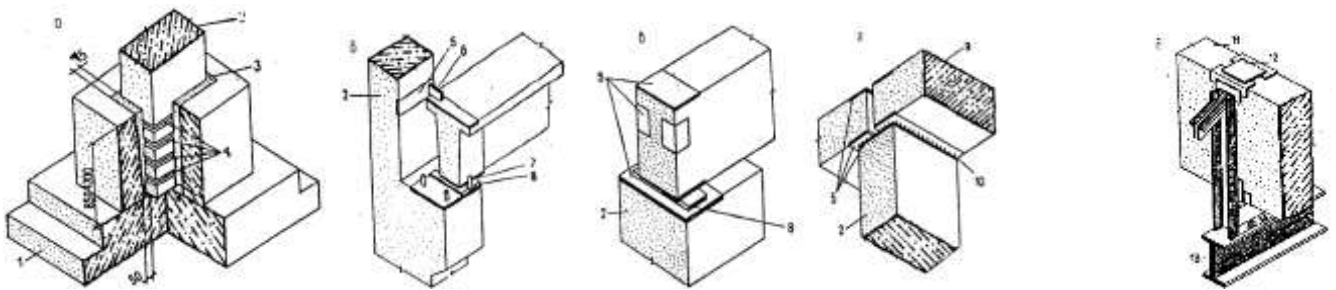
Вузли залізобетонного каркаса одноповерхових виробничих будівель: а – спряження колони з фундаментом;
